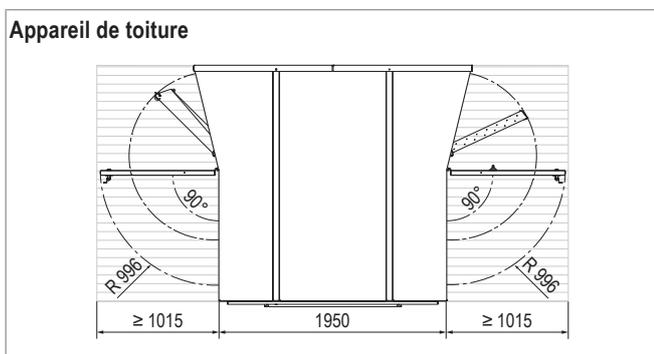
Espace nécessaire pour l'entretien sur la toiture (dimensions en mm)
